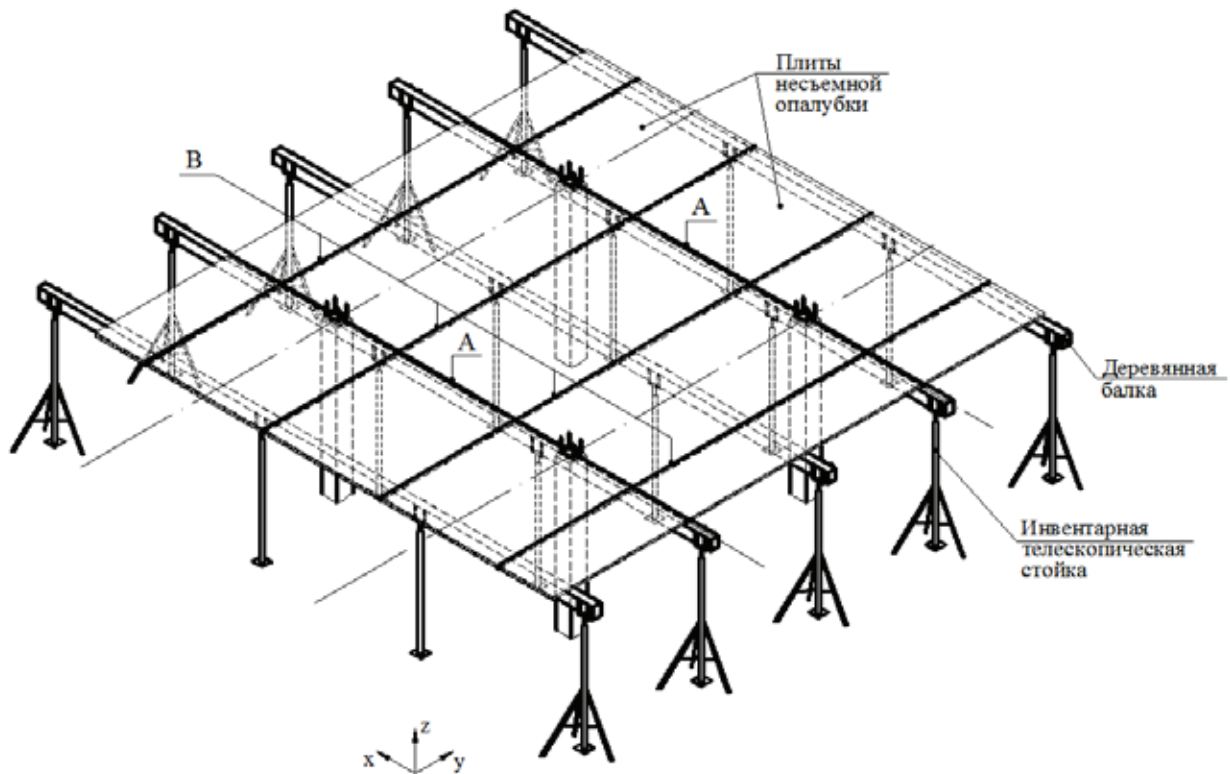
Монтажная схема сборно-монолитного перекрытия: А, В – типы сопряжения сборных элементов опалубки
